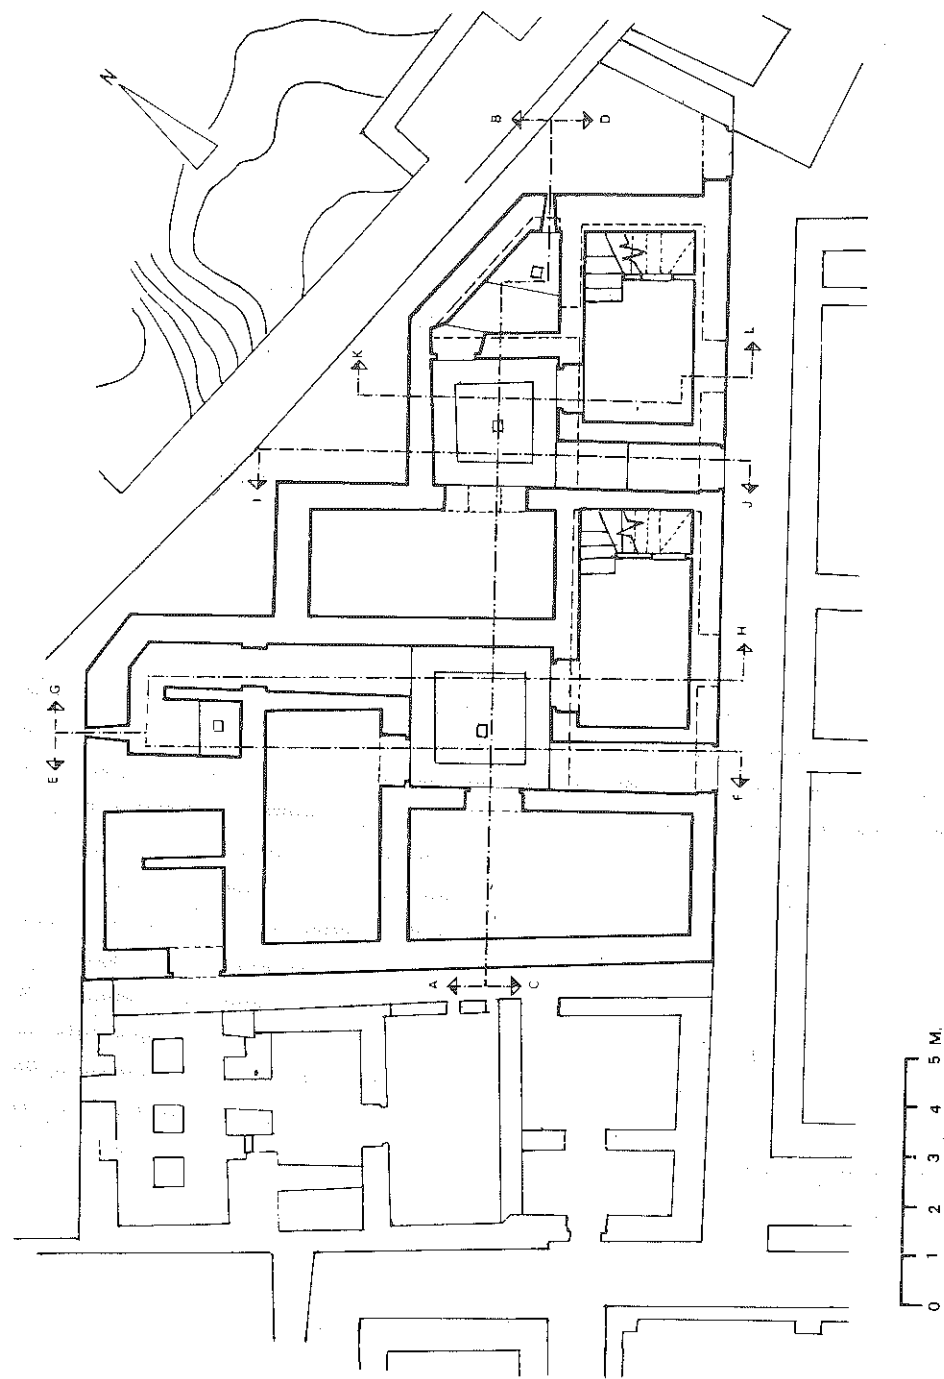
Alcazaba de Málaga. Barrio de casas árabes. Plano parcial de las casas 2 y 4 (según R. Puertas Tricas).
